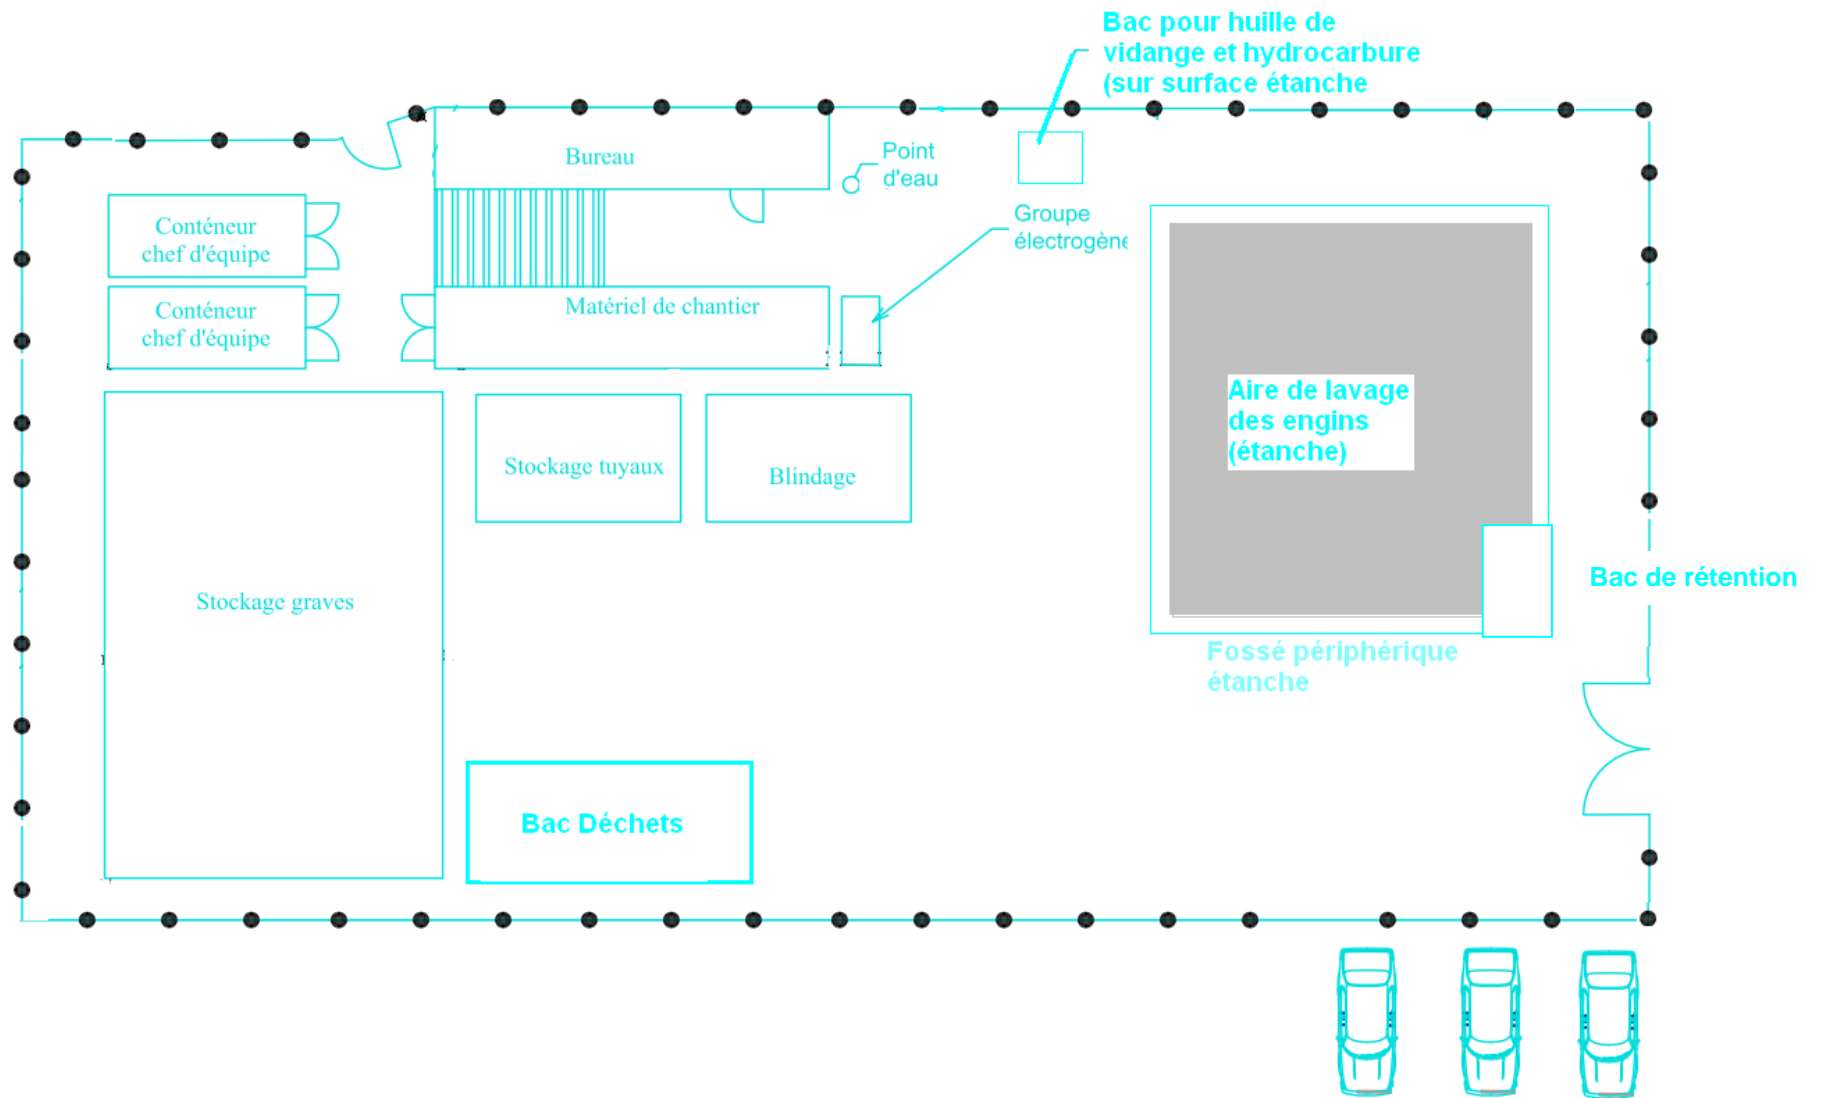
Plan d'installation de chantier et principe de collecte de seaux pluviales de l'aire de lavage
